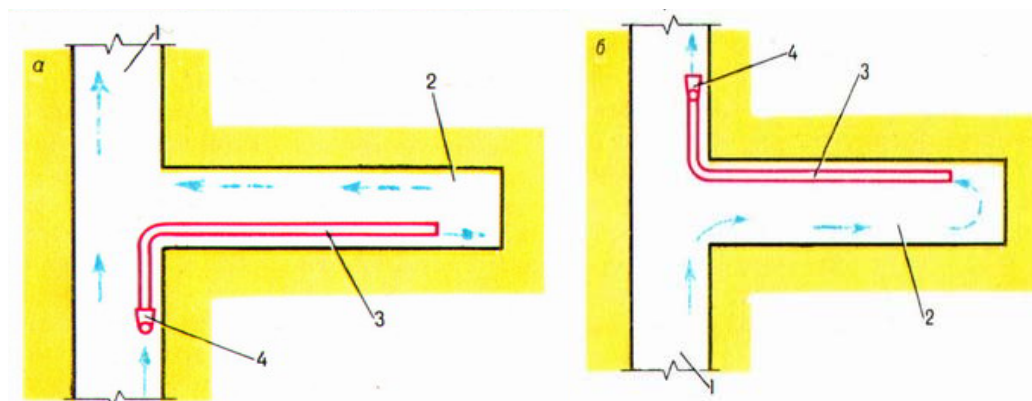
Проветривание тупиковых выработок с помощью вентиляторов местного проветривания: нагнетательным (а) и всасывающим (б) способами: 1 – сквозная воздухоподающая выработка; 2 – тупиковая выработка; 3 – вентиляционная труба; 4 – вентилятор местного проветривания
